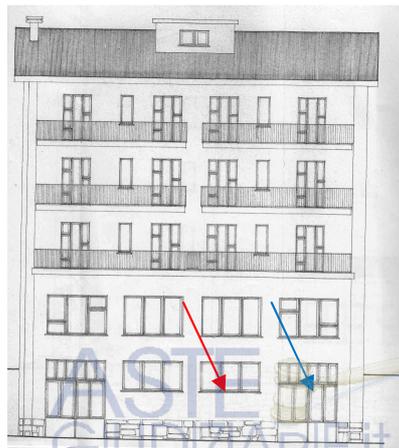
Confronto tra stato di fatto ed Estratto di Licenza Edilizia n.341/1971 (inversione di portone e finestra)
